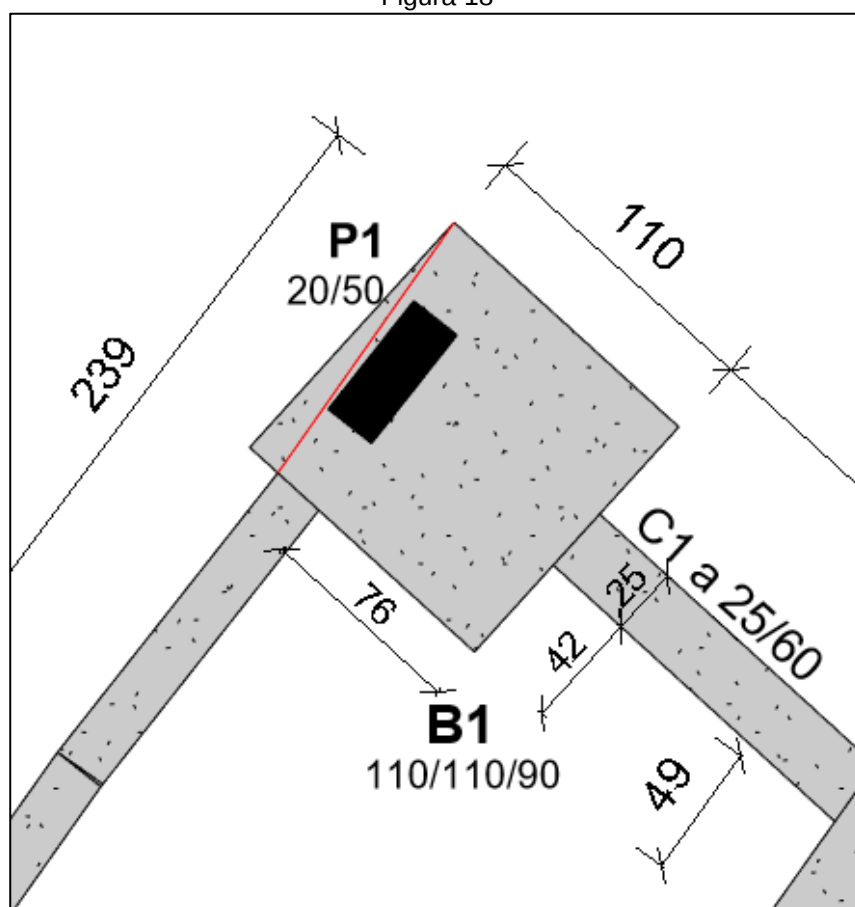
Bloco B1 da planta de Fundações, em CAD, com suas dimensões com variação.
